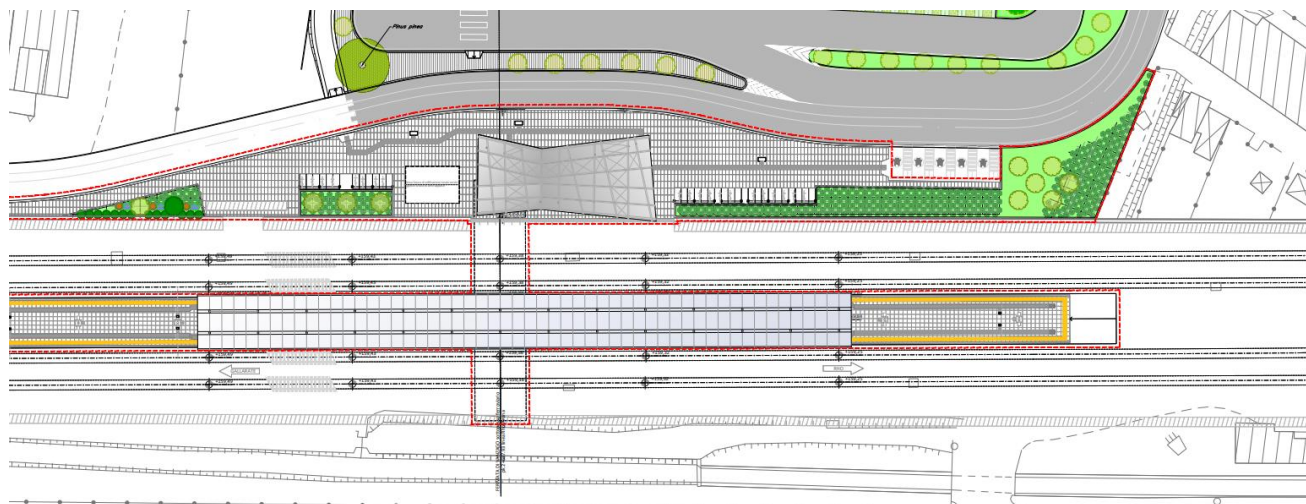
stralcio pianta nuovo sottopasso ferroviario
